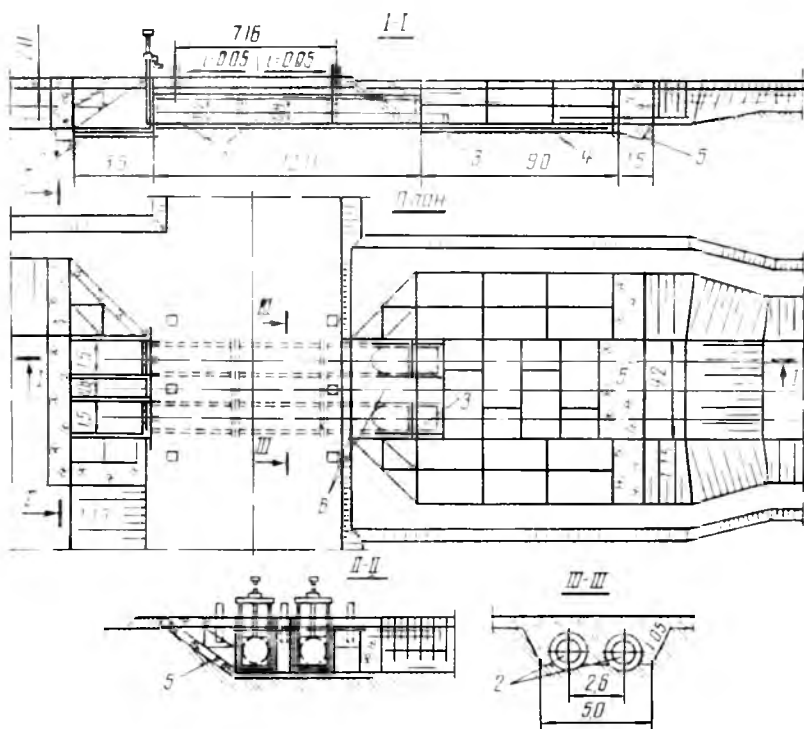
Двухочковый трубчатый регулятор с переездом:
